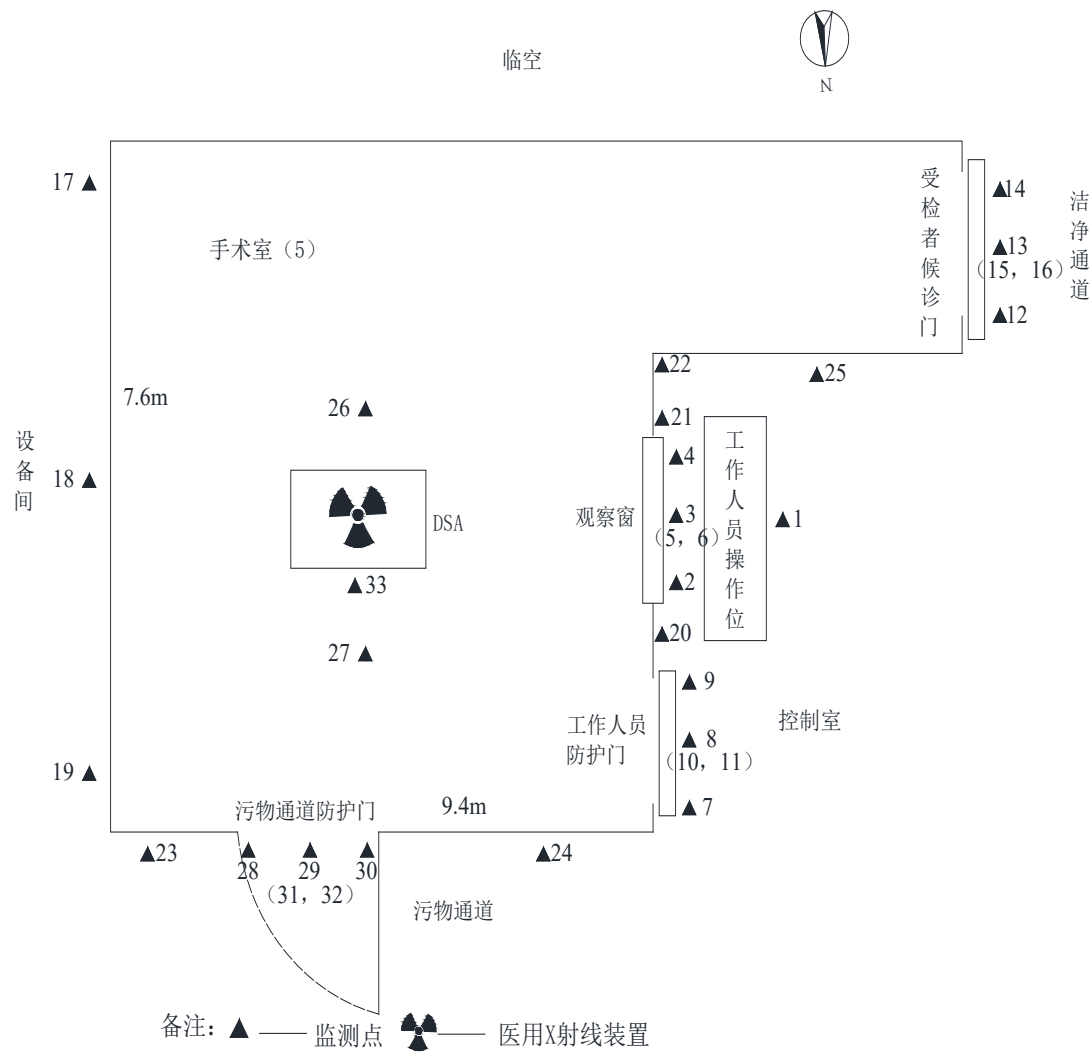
门诊医技楼 4 层手术室（5）辐射环境监测点布置平面图
